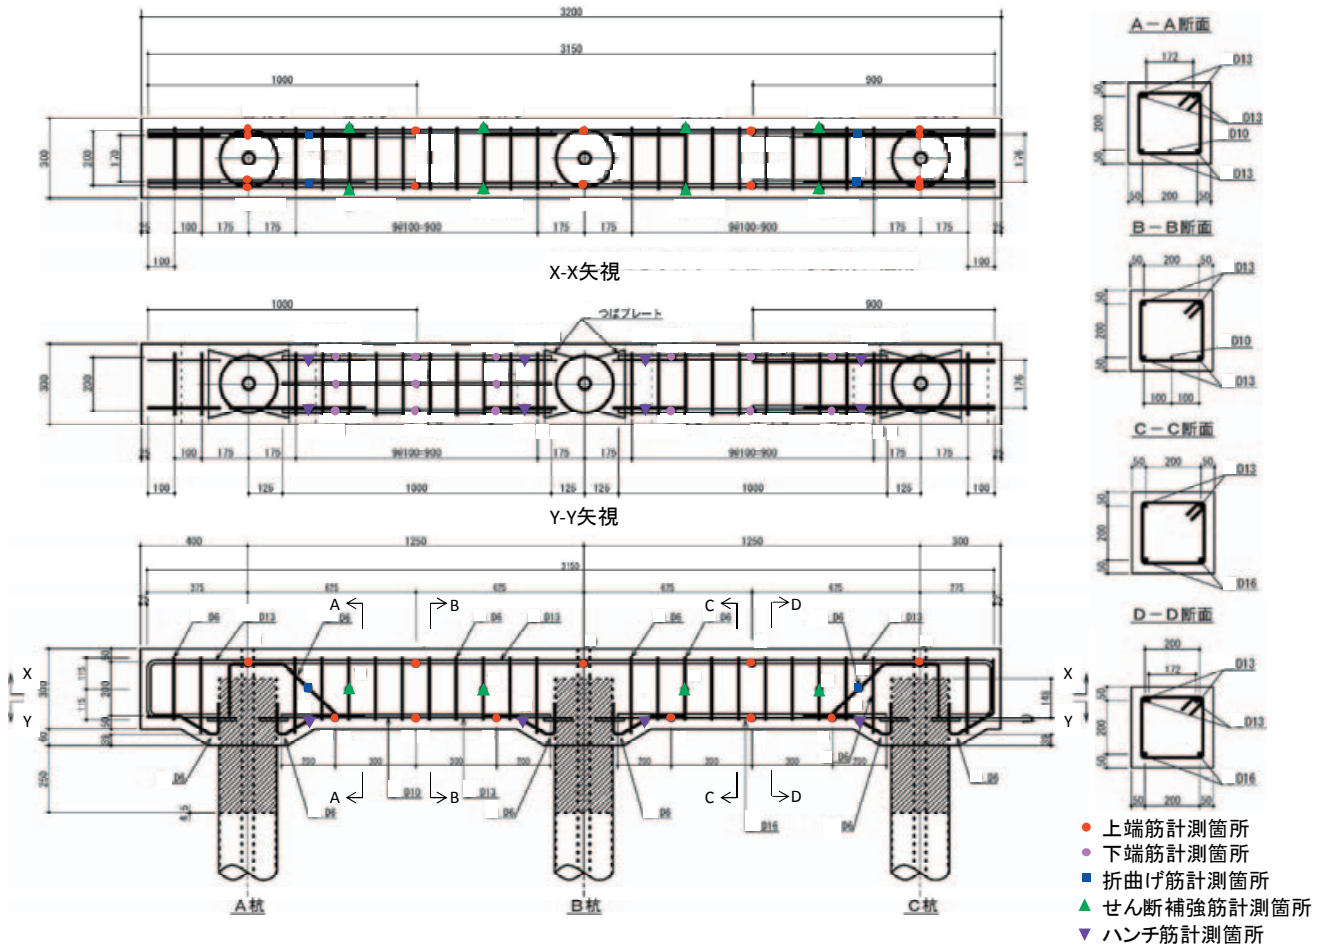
上部工の配筋図およびひずみ計測箇所（単位：mm）
